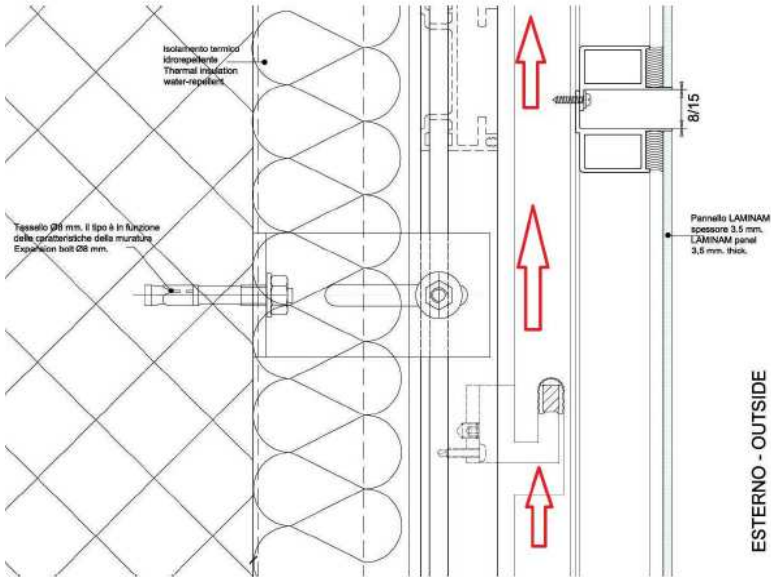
Fachada Laminam - Seção vertical: junta intermediária.
